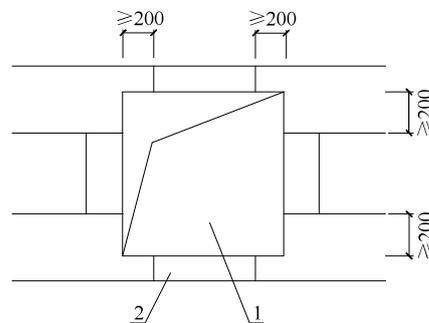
门窗洞口保温板排板示意（尺寸单位：mm）
